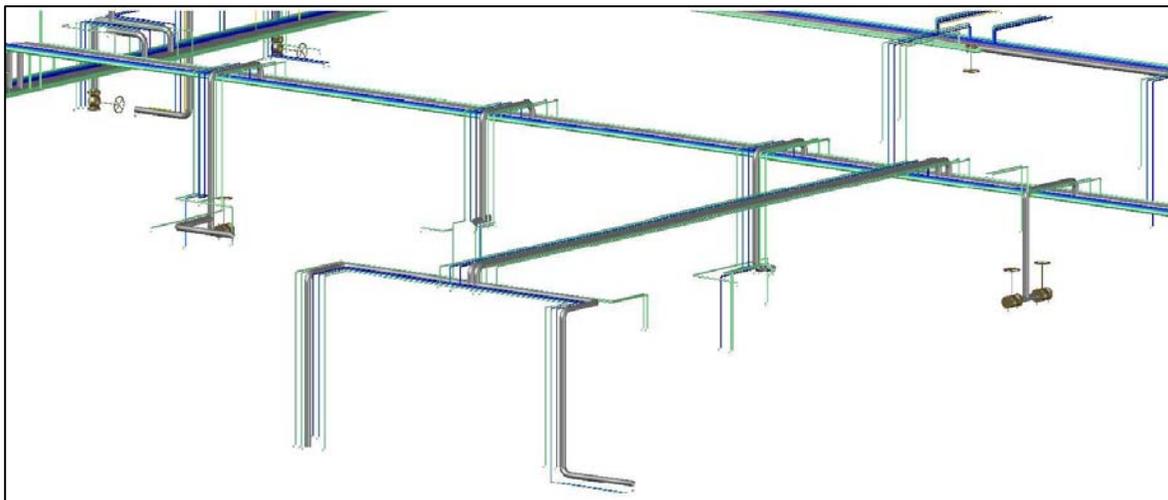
Modelo 3D de Tuberías en Planta Piloto FES Zaragoza (Vista 3).
